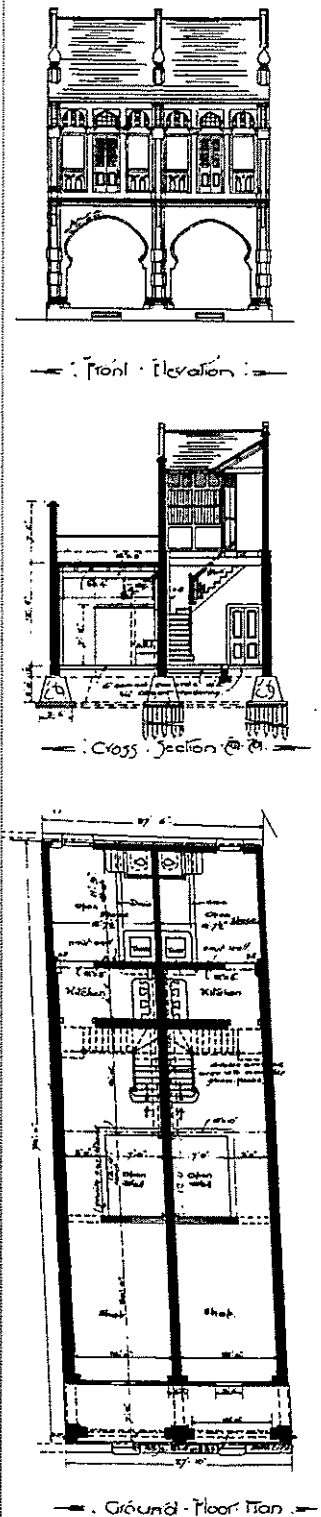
(oben) / Ausschnitte aus einem Gebäudeplan von 1911/16 (Nr. 714): Ansicht, Schnitt und Grundriß Erdgeschoss / Quelle: Bau und Planungsamt, Municipal Council of Pulau Penang
